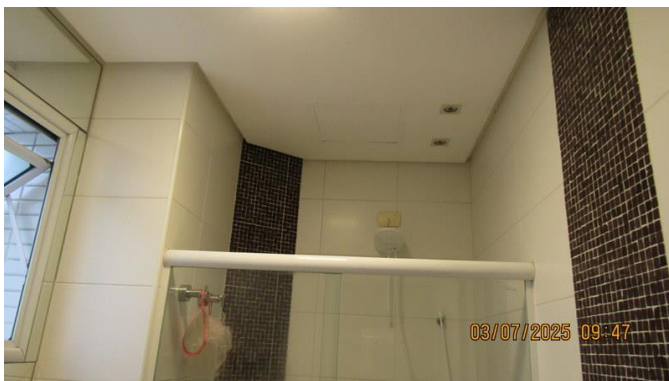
Outra vista do WC da suíte do imóvel avaliando.
